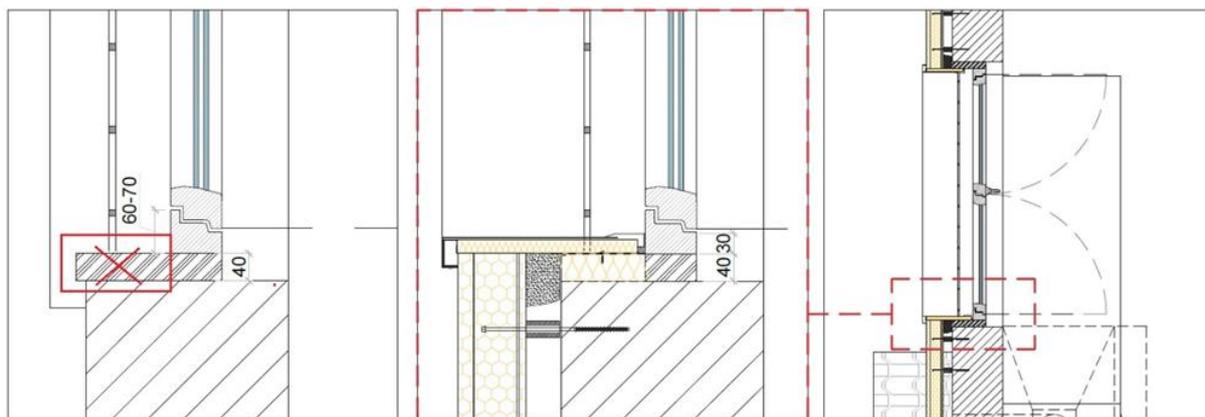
Sezione di dettaglio orizzontale della finestra – Stato di Fatto e di Progetto
